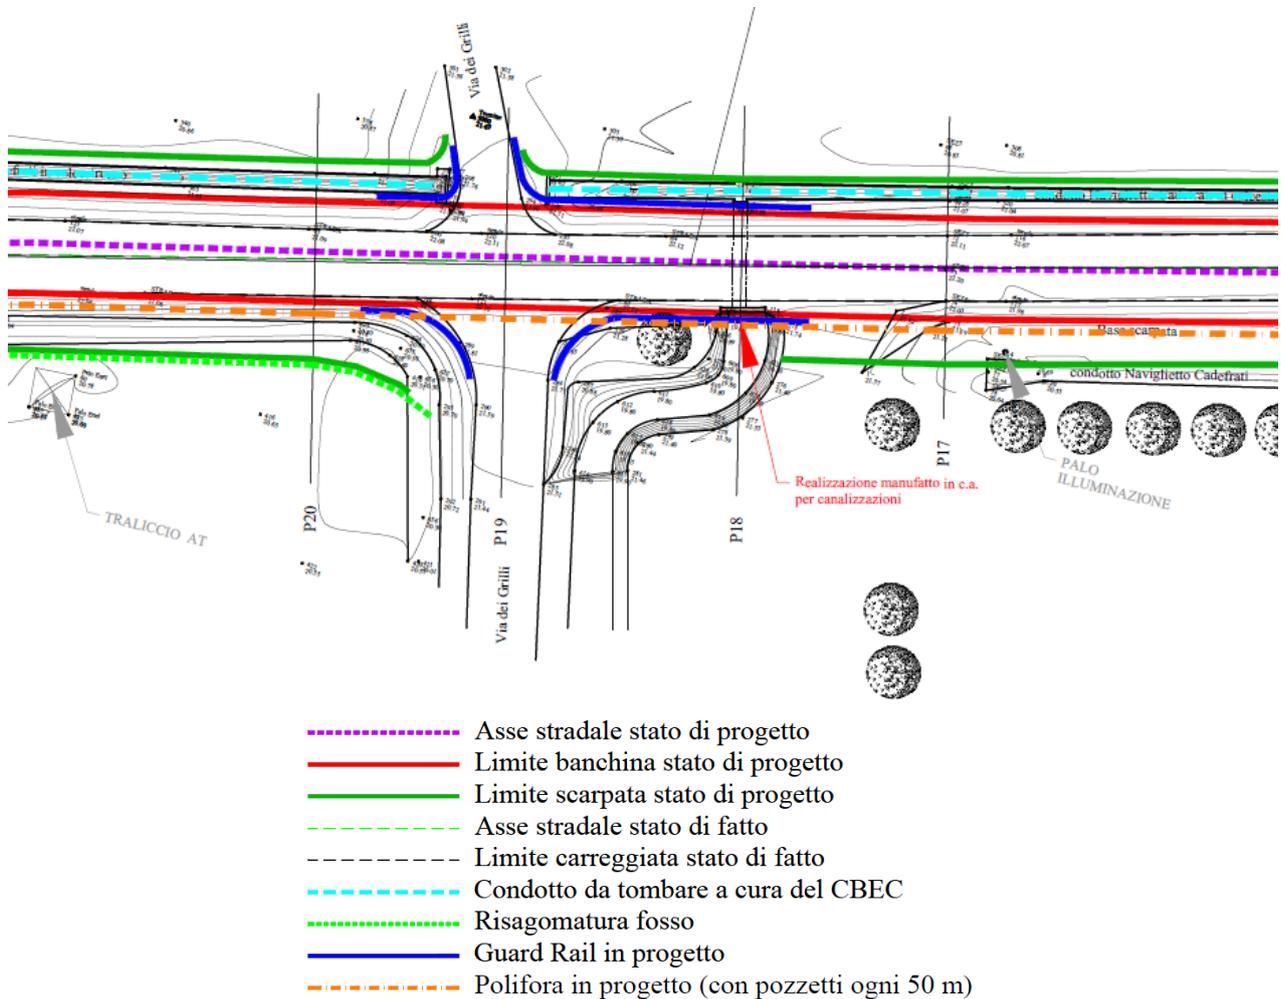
Planimetria di parte del tratto oggetto di intervento.
